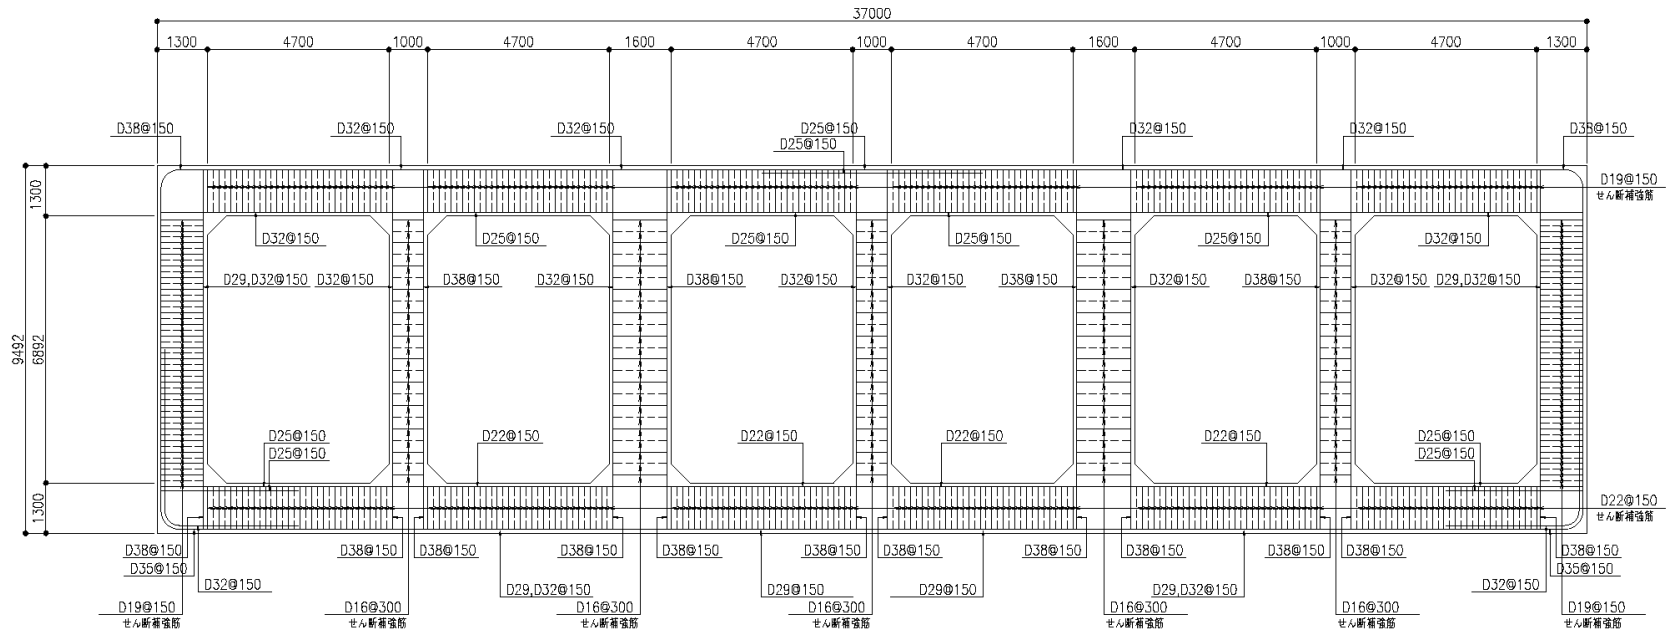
取水路 (6号機設備) の配筋図 (漸縮部, A-A断面)
